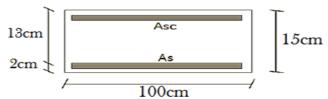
Dimensions de la section transversale de la dalle pleine(RDC)
